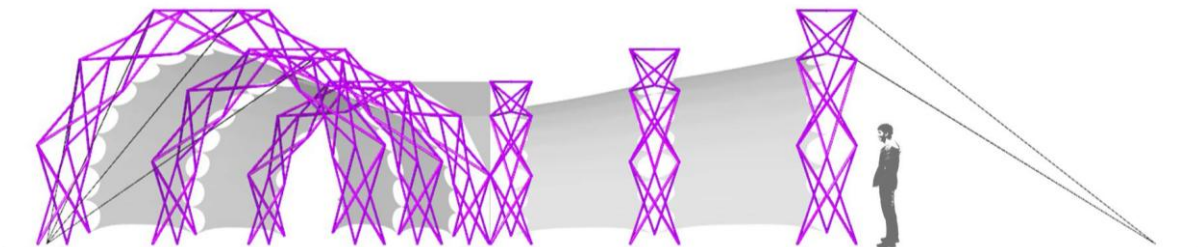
Pabellón Vertex. Geometría vista en alzado.
